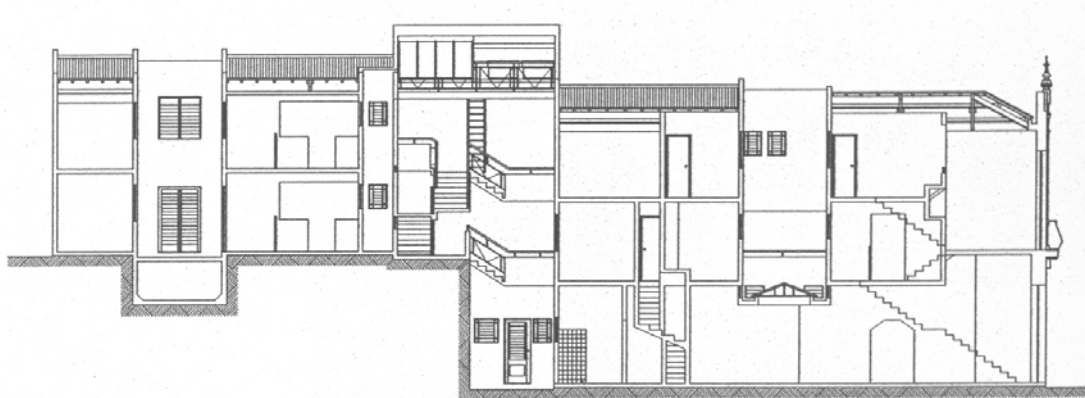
Rua do Livramento, 145 – Corte longitudinal (SECRETARIA, 2000, p. 52).
